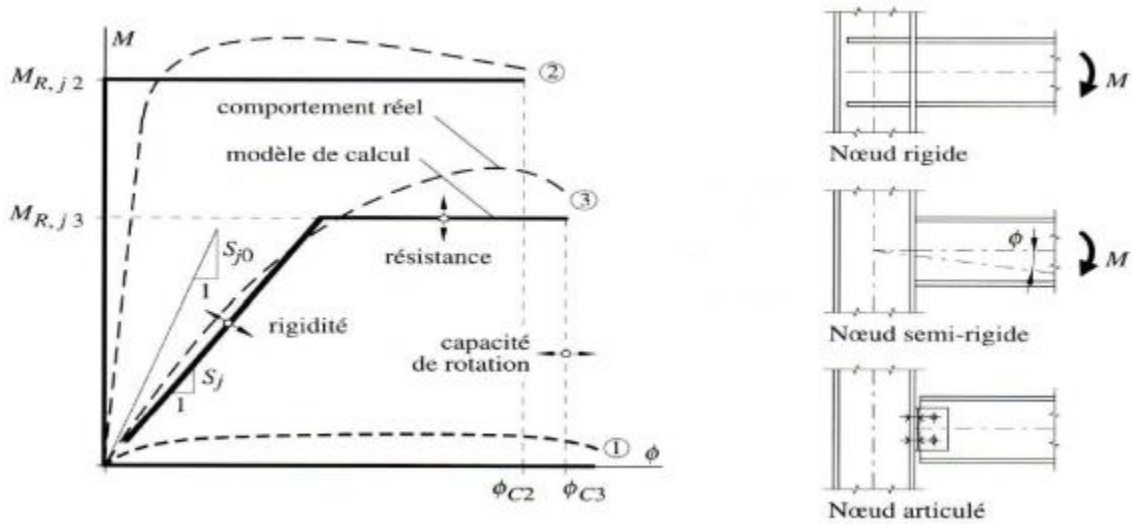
Comportement d'un assemblage poteau-poutre.
